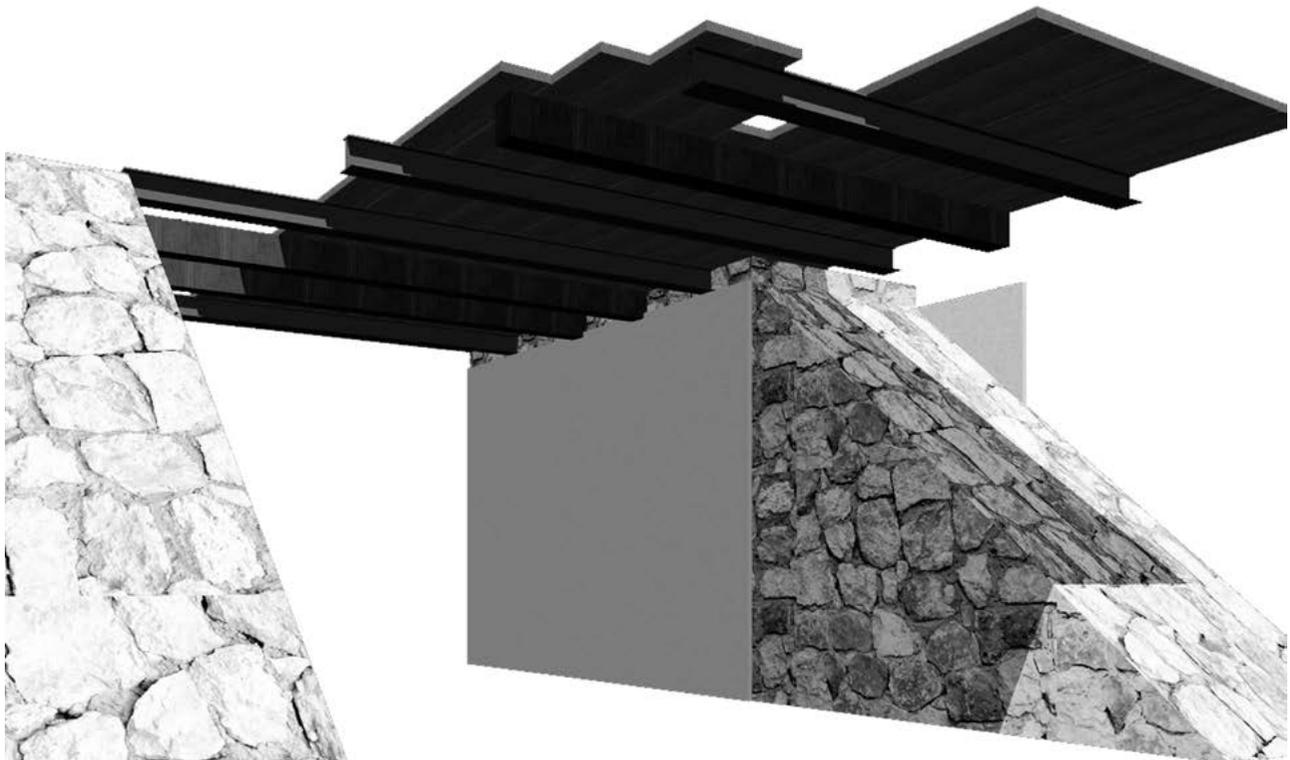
Detalle de bagacera (entresuelo) en la casa de máquinas de la hacienda de Yaxché de Peón. Fuente: Roberto Reyes.
